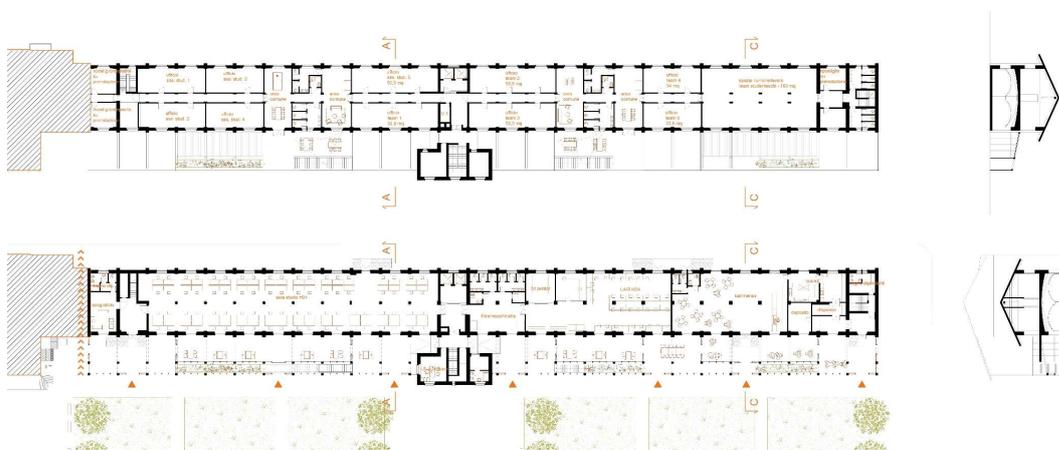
Planimetria di progetto e sezioni del nuovo distaccamento del Politecnico di Torino.
